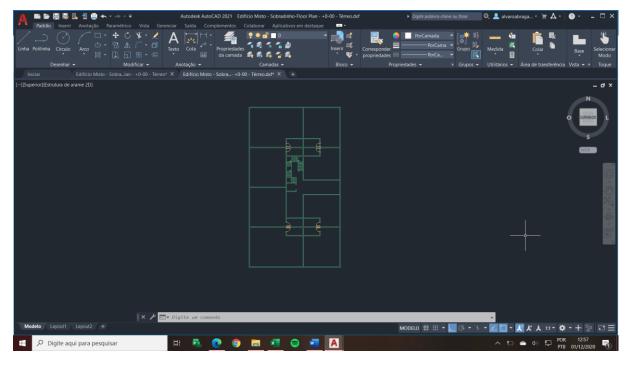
Planta baixa do térreo, em DWG. Realizado pelo autor.
